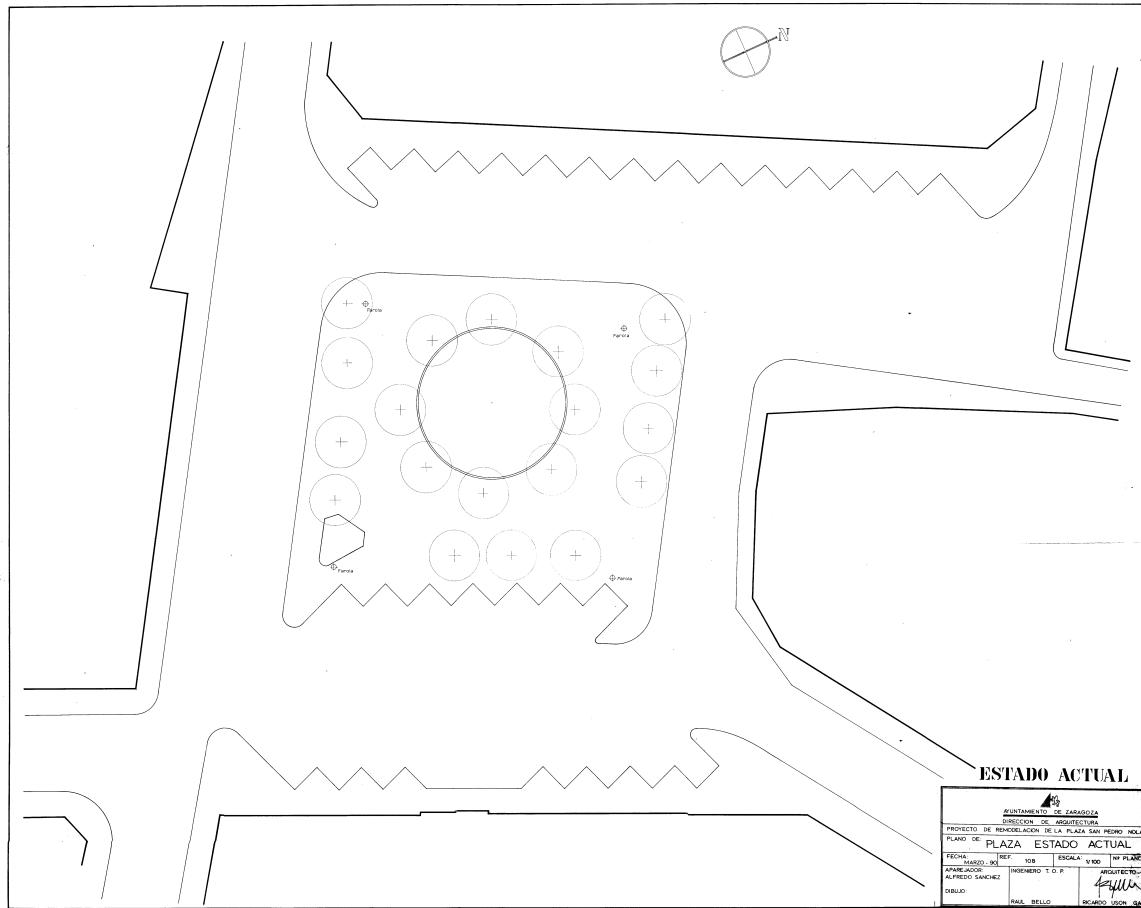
Detalle de plano de 1965 de la Plaza San Pedro Nolasco
